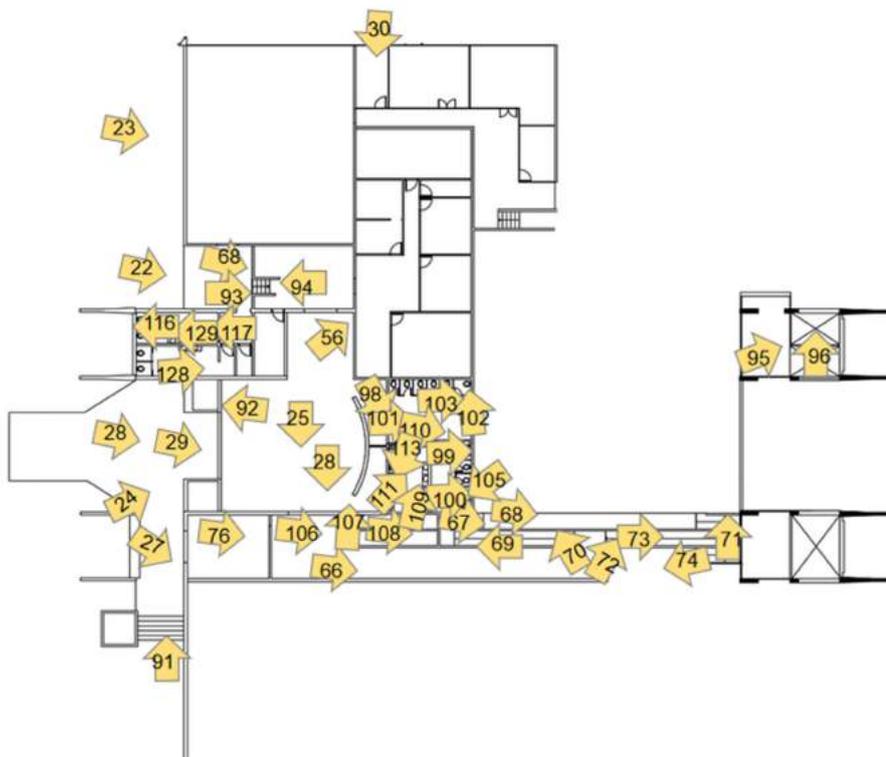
Planta do RU – primeiro pavimento – Montagem Autor: Valentim, M. 2020
